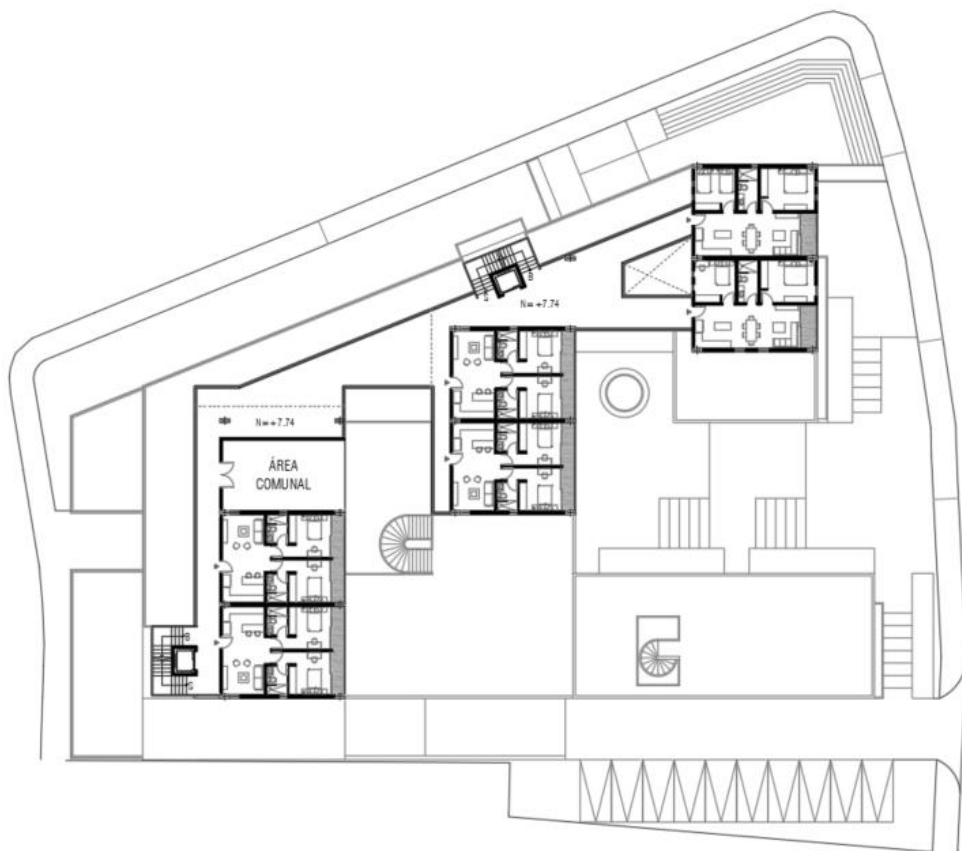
Planta alta 02 - Anteproyecto 02. Elaboración propia.
